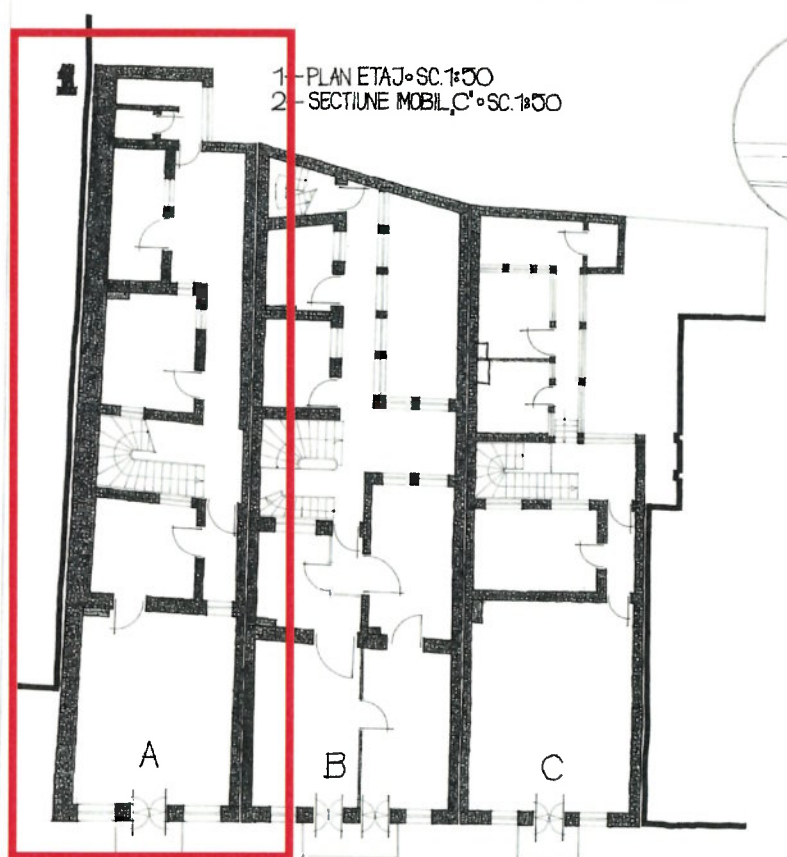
Imobile din strada Bărăției (nr. 48) – plan parter
